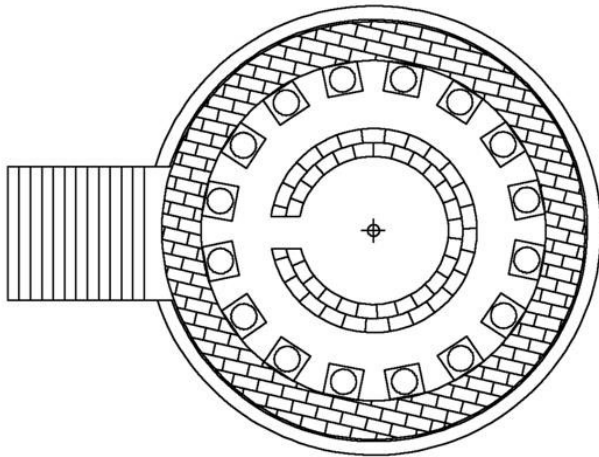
Tivoli, Villa Adriana, c.d. Sepolcro. Ricostruzione della planimetria della tholos (elaborazione di P. Pensabene, disegno di E. Gallochio).
